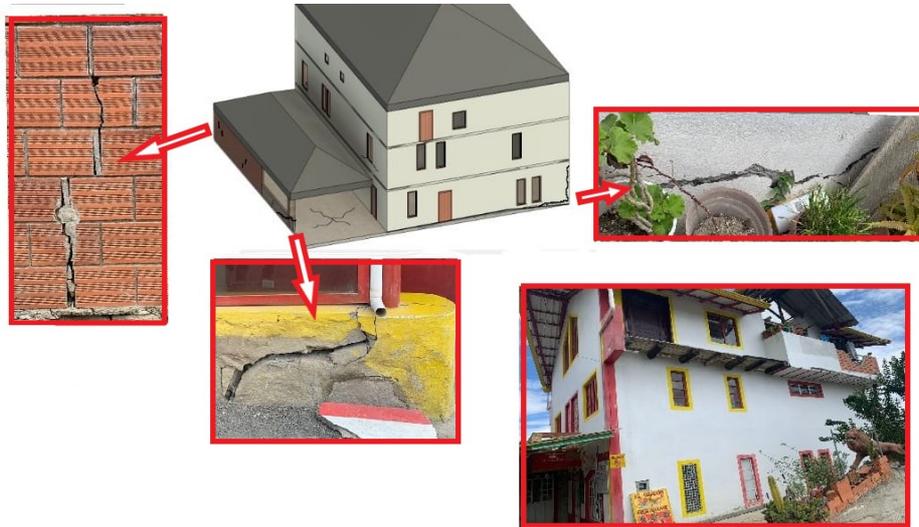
Casa 15. Detalle de fisuras en vivienda esquematizada.
